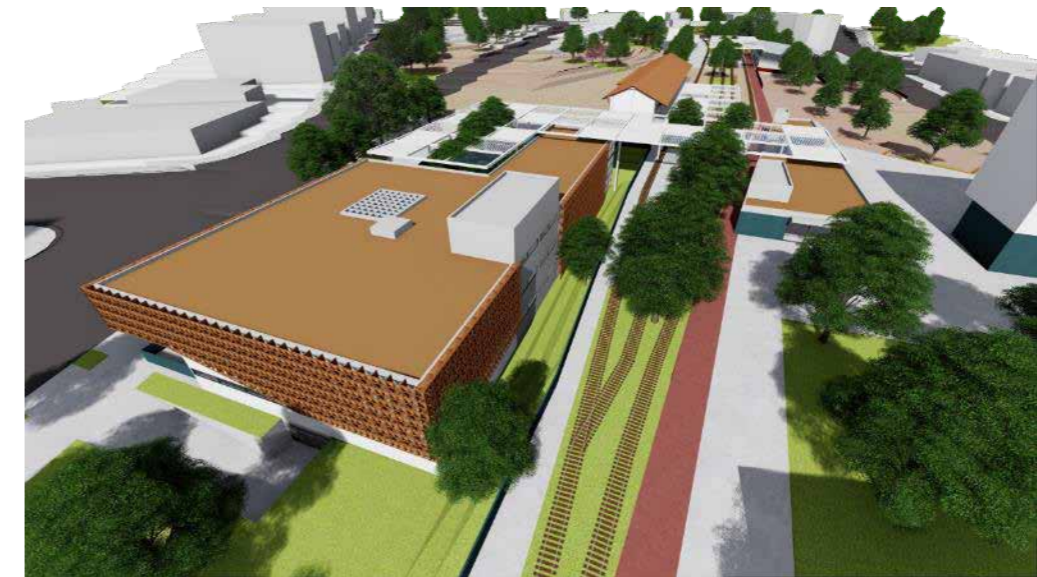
Vista geral do bloco principal e dos estudantes. Detalhe para o brise nas fachadas norte /leste e para o talude.
